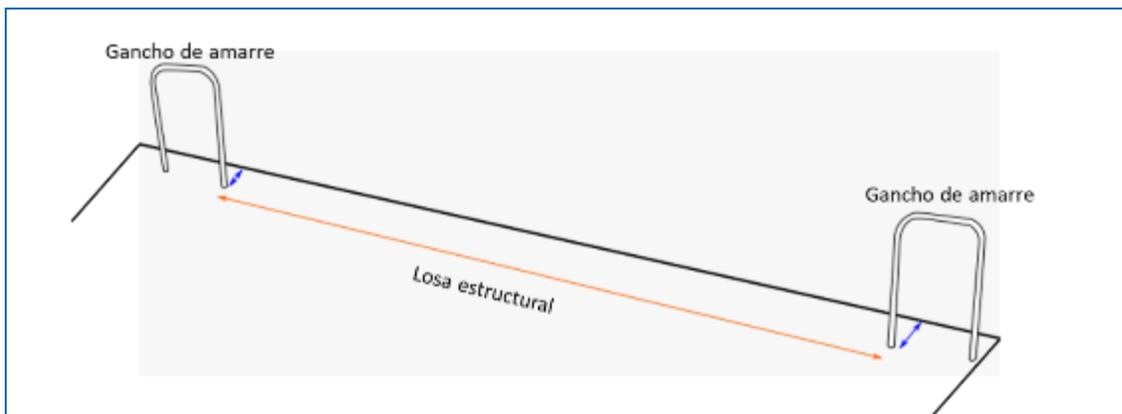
Recomendación de ubicación de ganchos de amarre de la red en el elemento de hormigón –Elaboración propia
